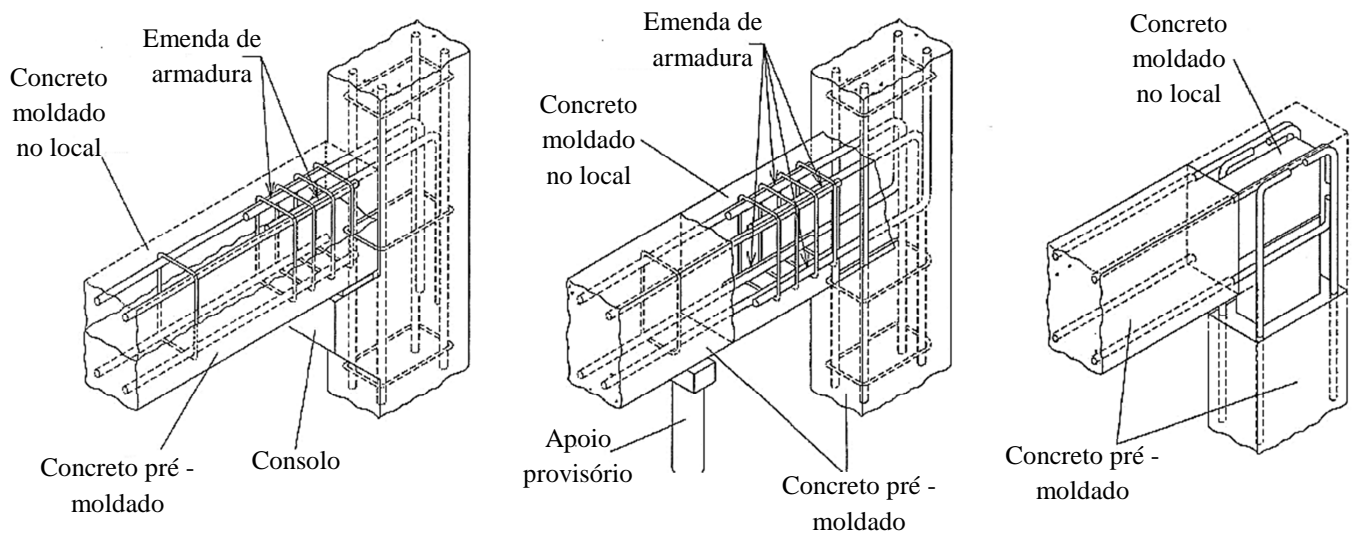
Ligações viga-pilar rígidas com emenda da armadura e concreto moldado no local [EL DEBS (2000)].
